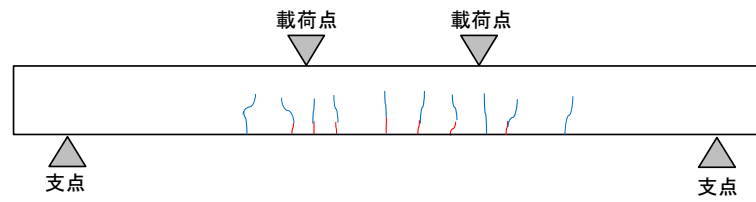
IBPM 製 RC 梁のひび割れ発生状況
